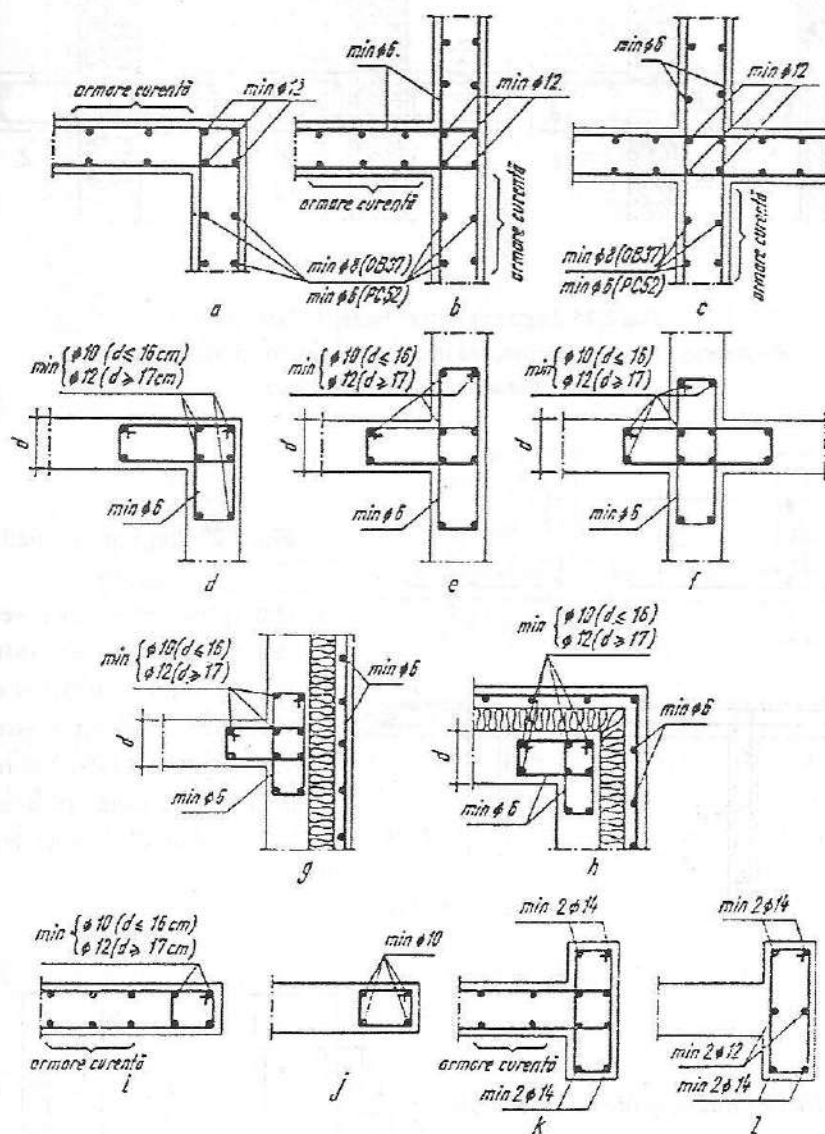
Detalii de armare a pereților din beton armat monolit la colțuri, intersecții.
